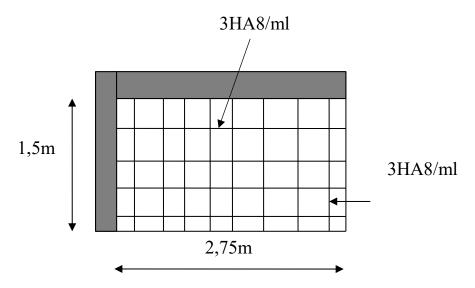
Schéma de ferraillage d'une dalle sur 2 appuis.
